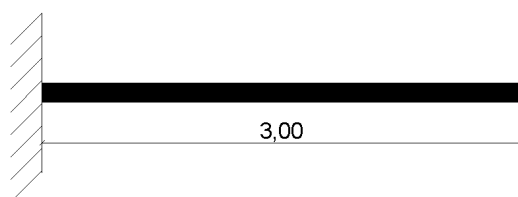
Viga engastada em balanço, dimensão em metros
